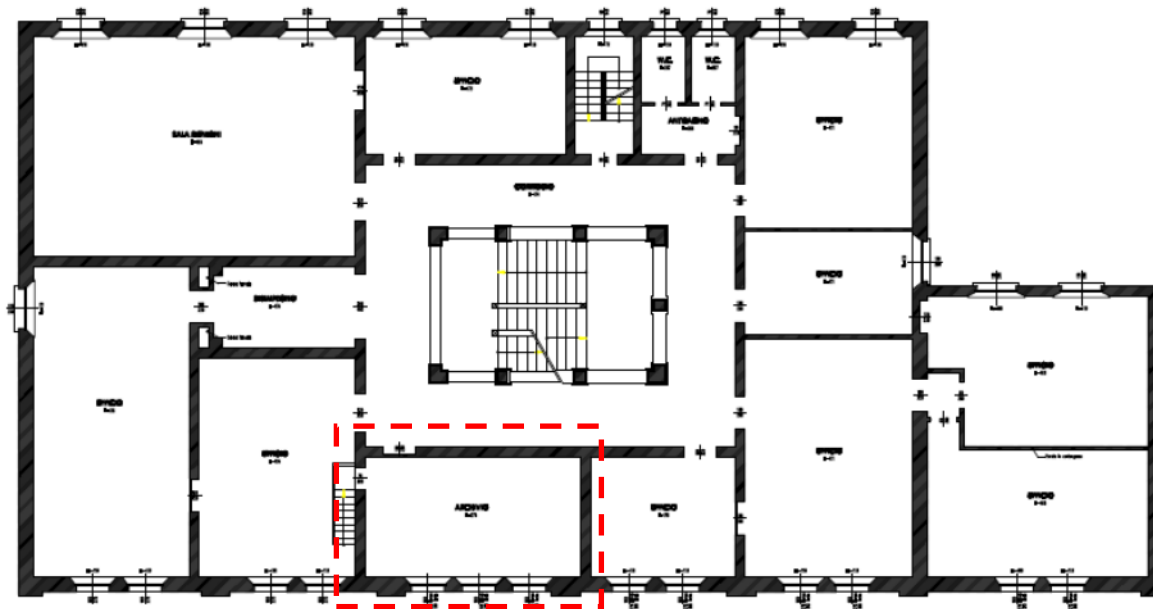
Pianta piano primo, con localizzazione del mezzanino
